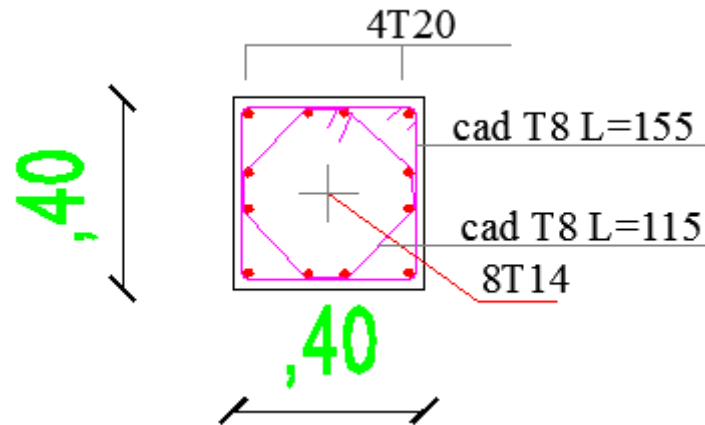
Vue en plan du ferrailage des armatures du poteau ( 40 × 40 )
